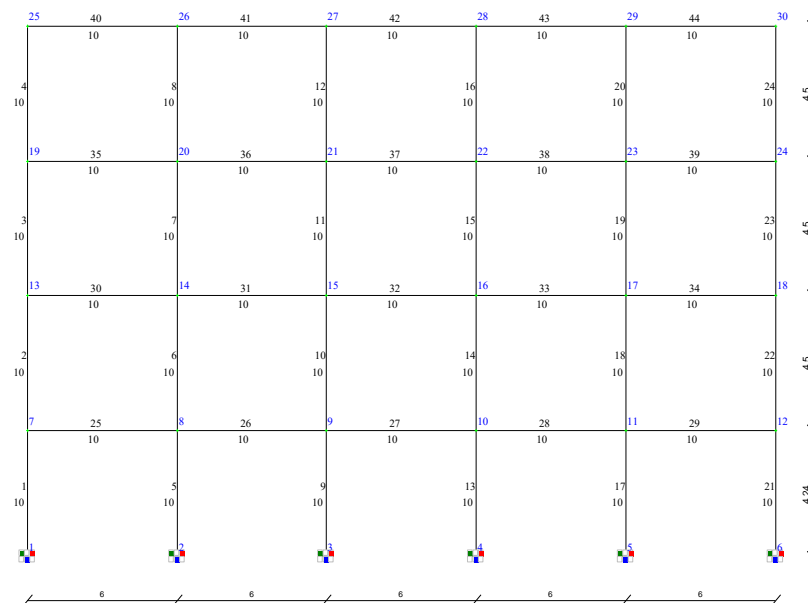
Розрахункова схема поперечної рами каркасу будівлі
